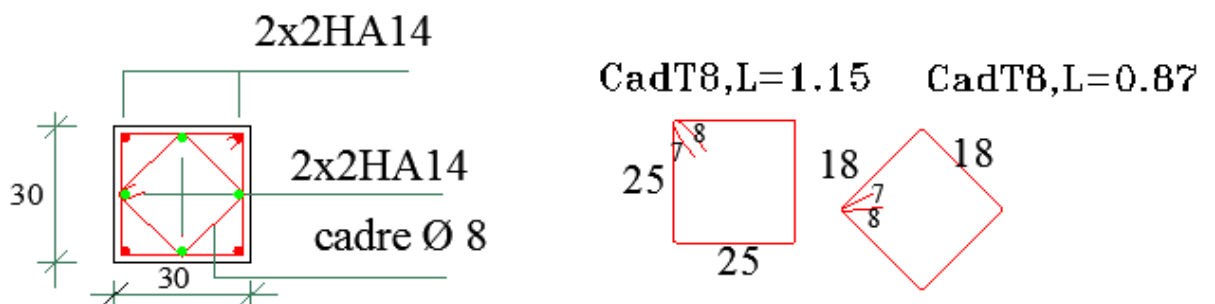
Disposition des armatures dans les poteaux (30x30)
